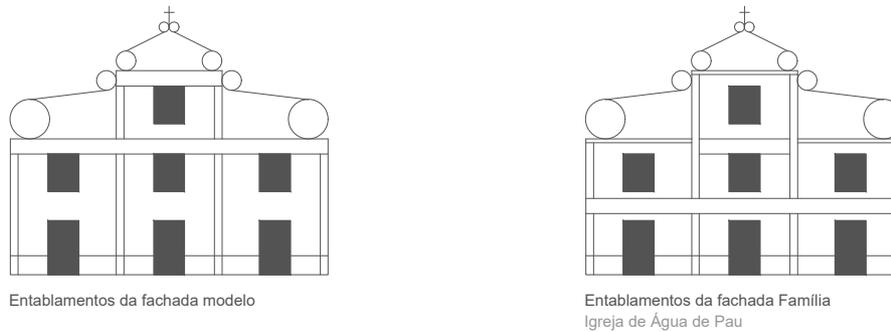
Comparação de entablamento da fachada modelo com a fachada família
